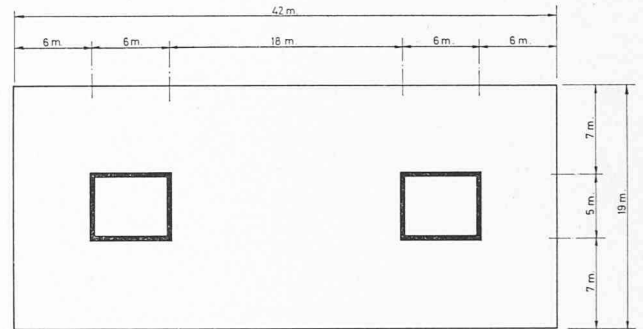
Structure plissée : noyaux. Disposition en plan.
